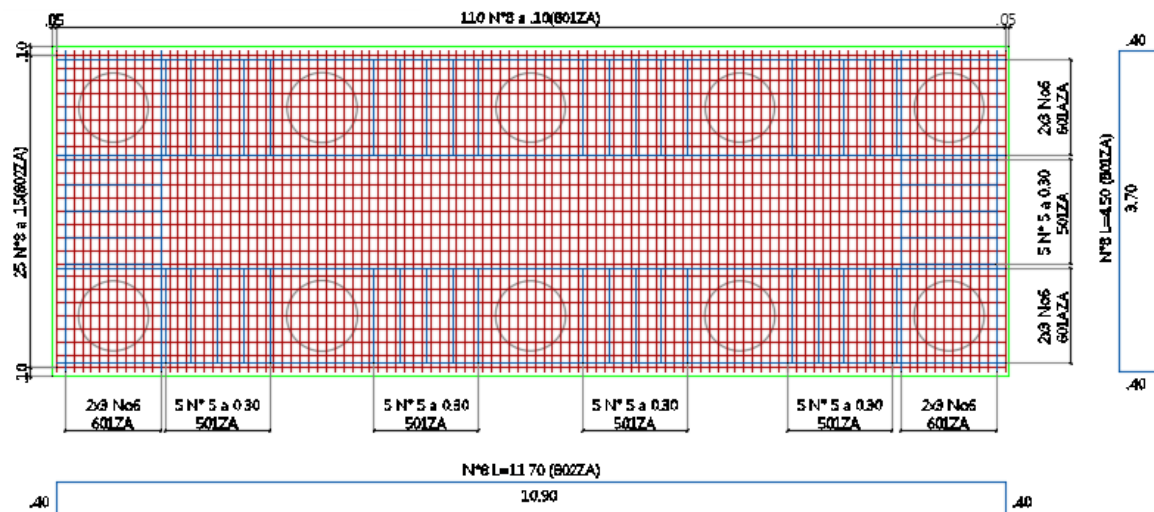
Detalle refuerzo superior zapata sobre el eje 2 y 3. (Dis Diseñadores)
